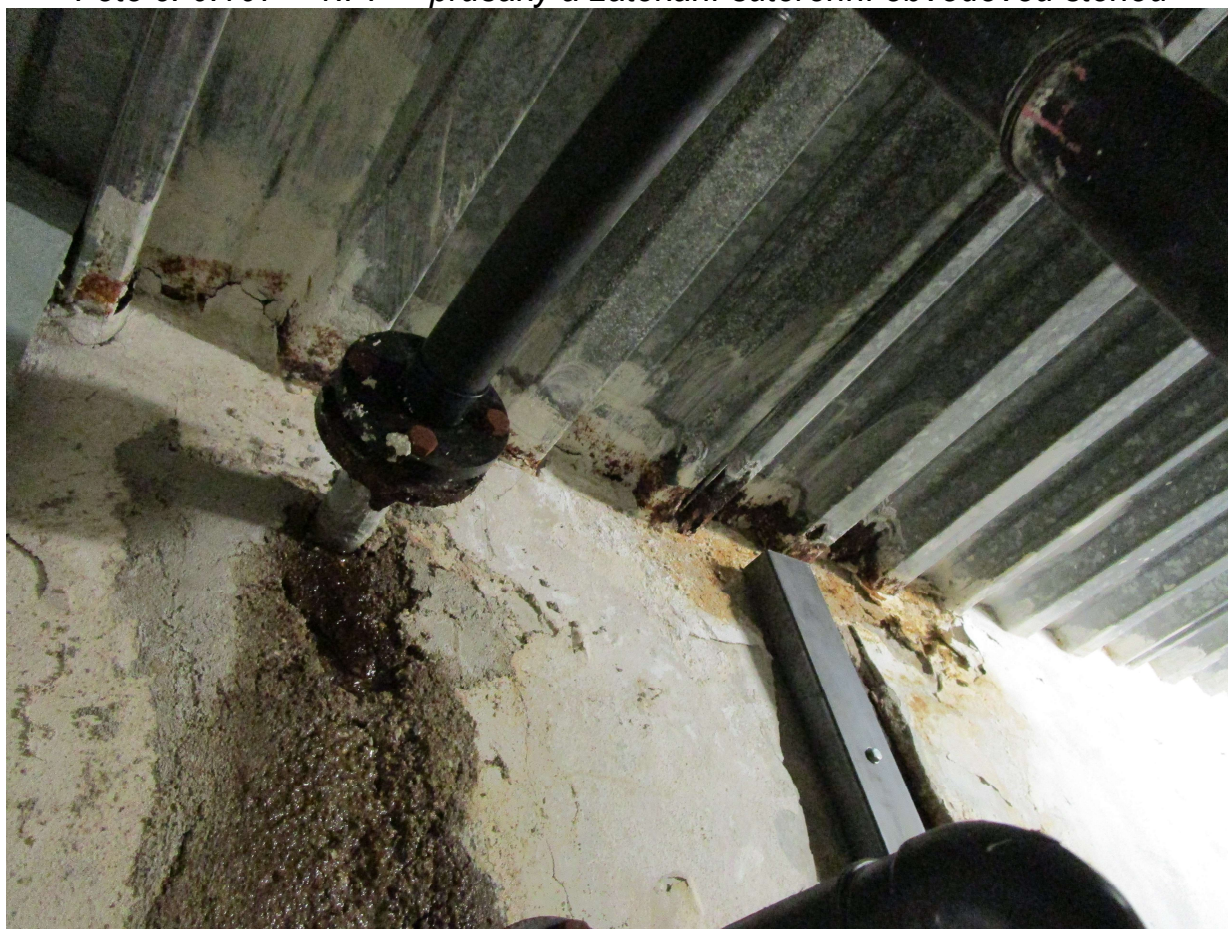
1.PP – zatékání a koroze trapézového plechu na spodním líci stropu
